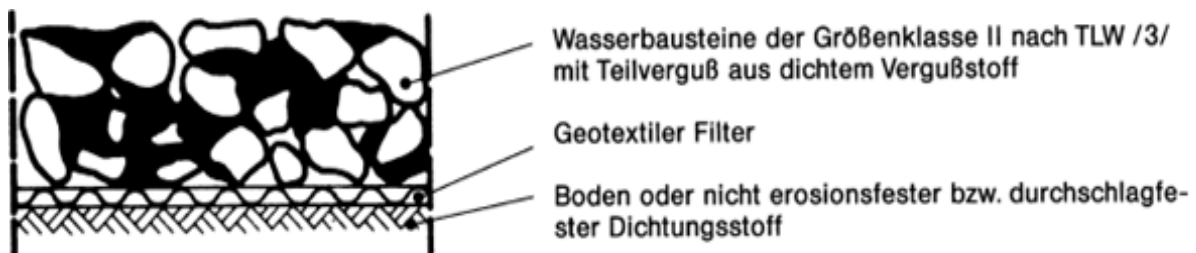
Schematische Darstellung einer durchlässigen Deckschicht aus teilvergossenen Wasserbausteinen im Querschnitt. Siehe die Erläuterung zu Bild 4.2.1 [48];[86]
